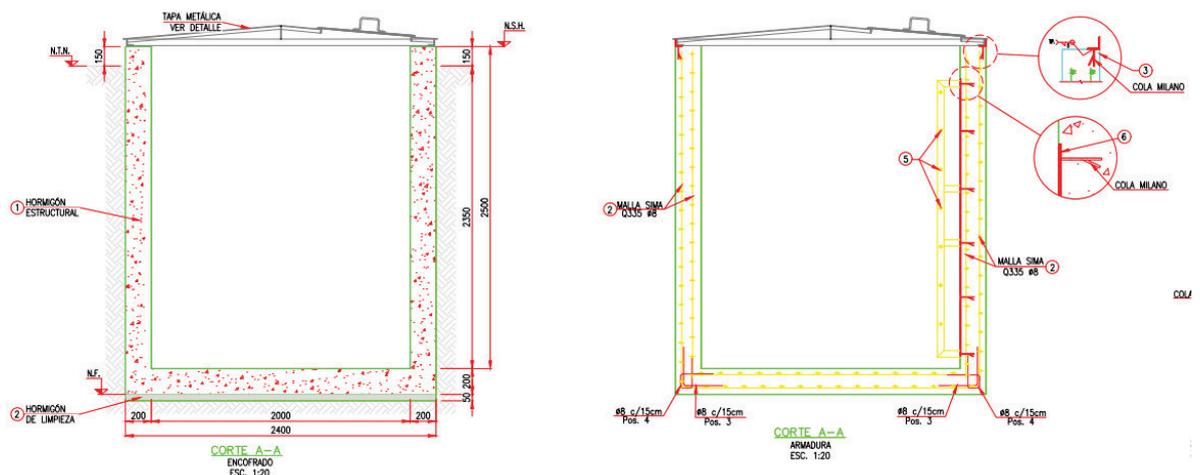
Vista en corte de cámara. Hormigón y armadura.
